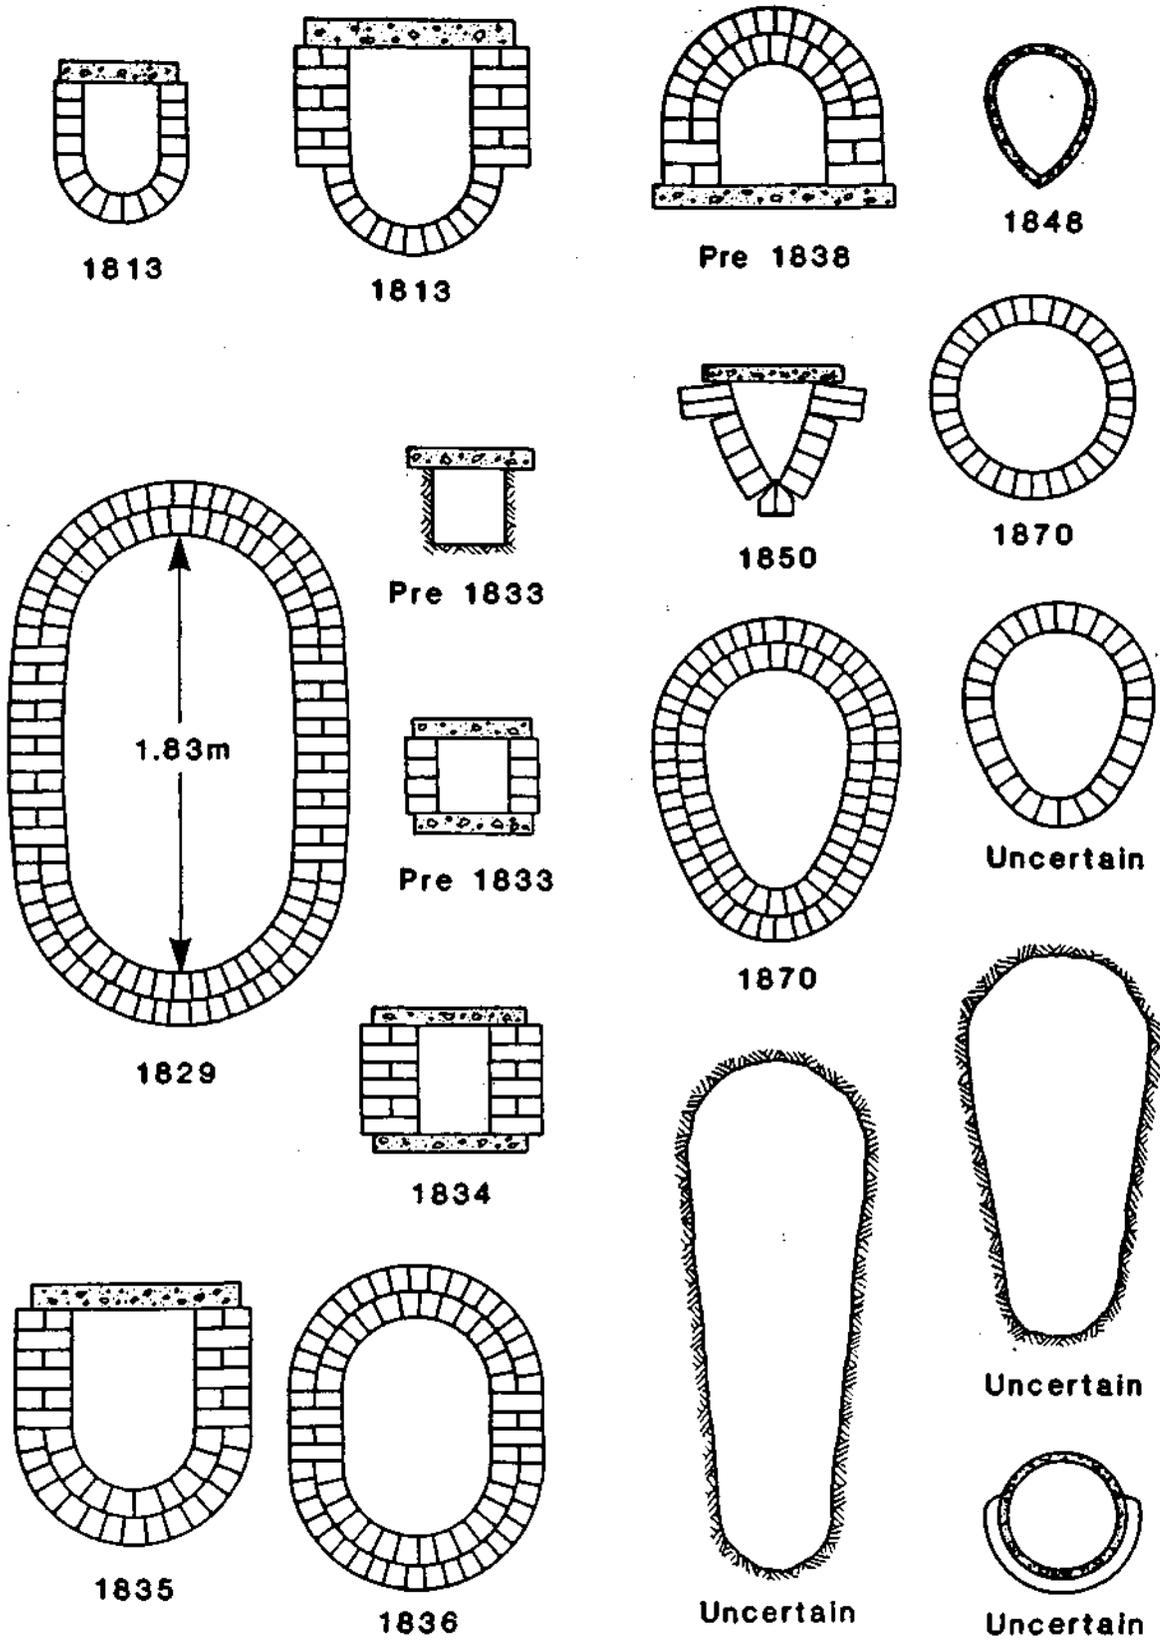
Sections des collecteurs d'assainissement de Manchester
